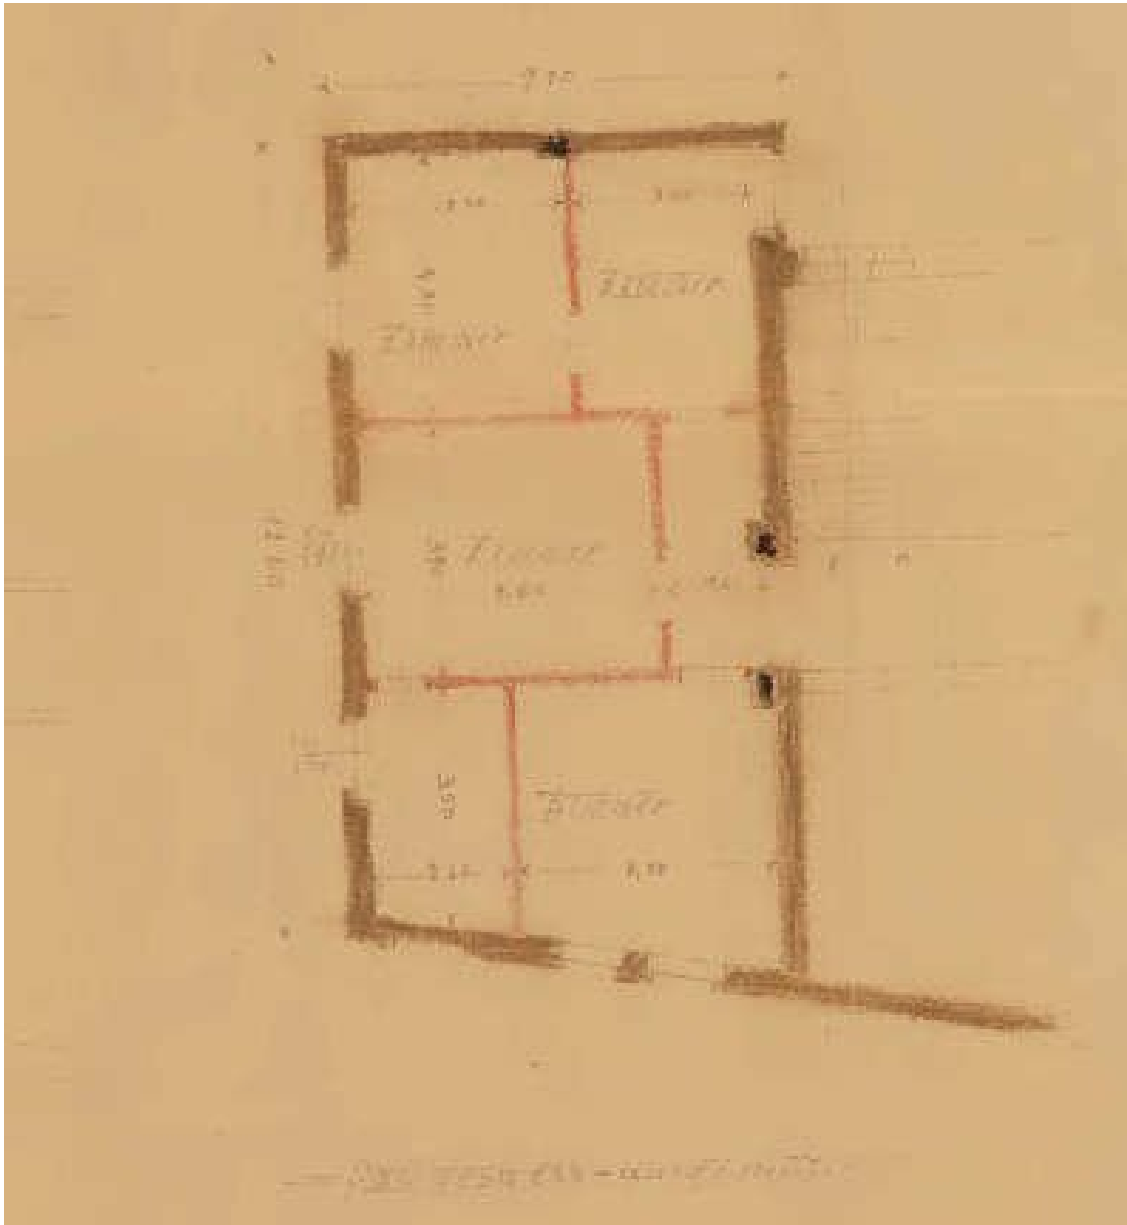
Ausbau 2. Obergeschoss (Mansardgeschoss) Haus Nr. 14
